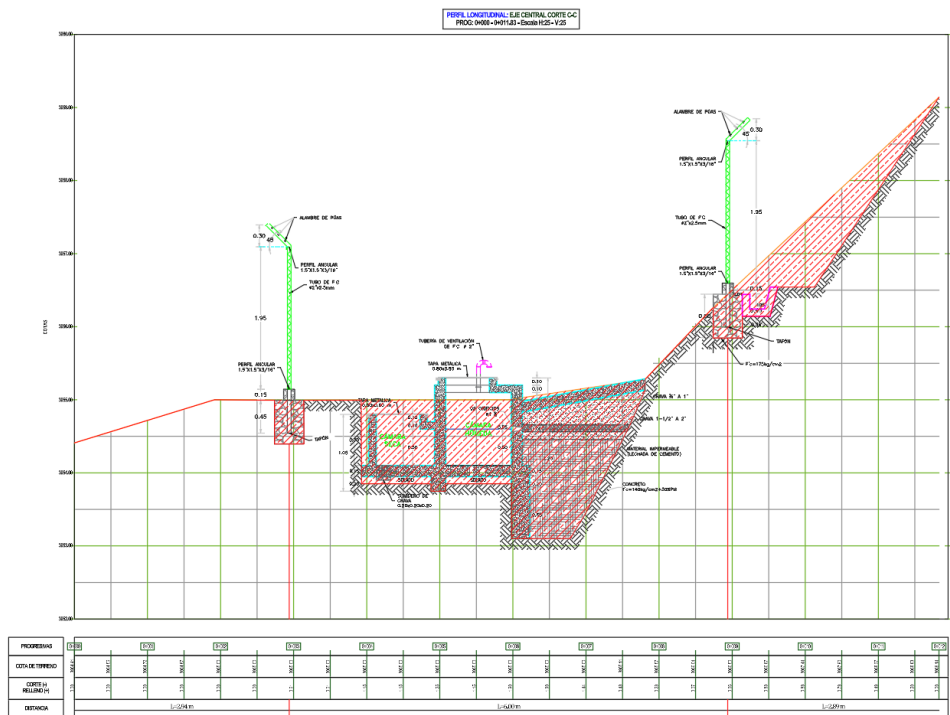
Perfil longitudinal de la Captación La Laja.
